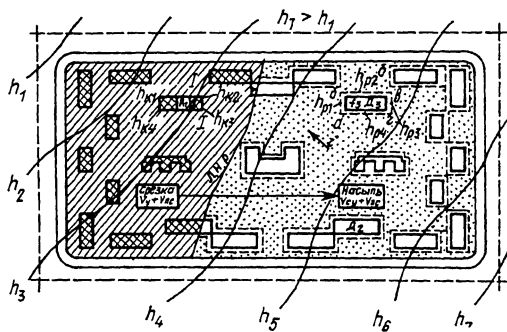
Распределение земляных масс при планировке квартала и разработке грунта в котлованах:
